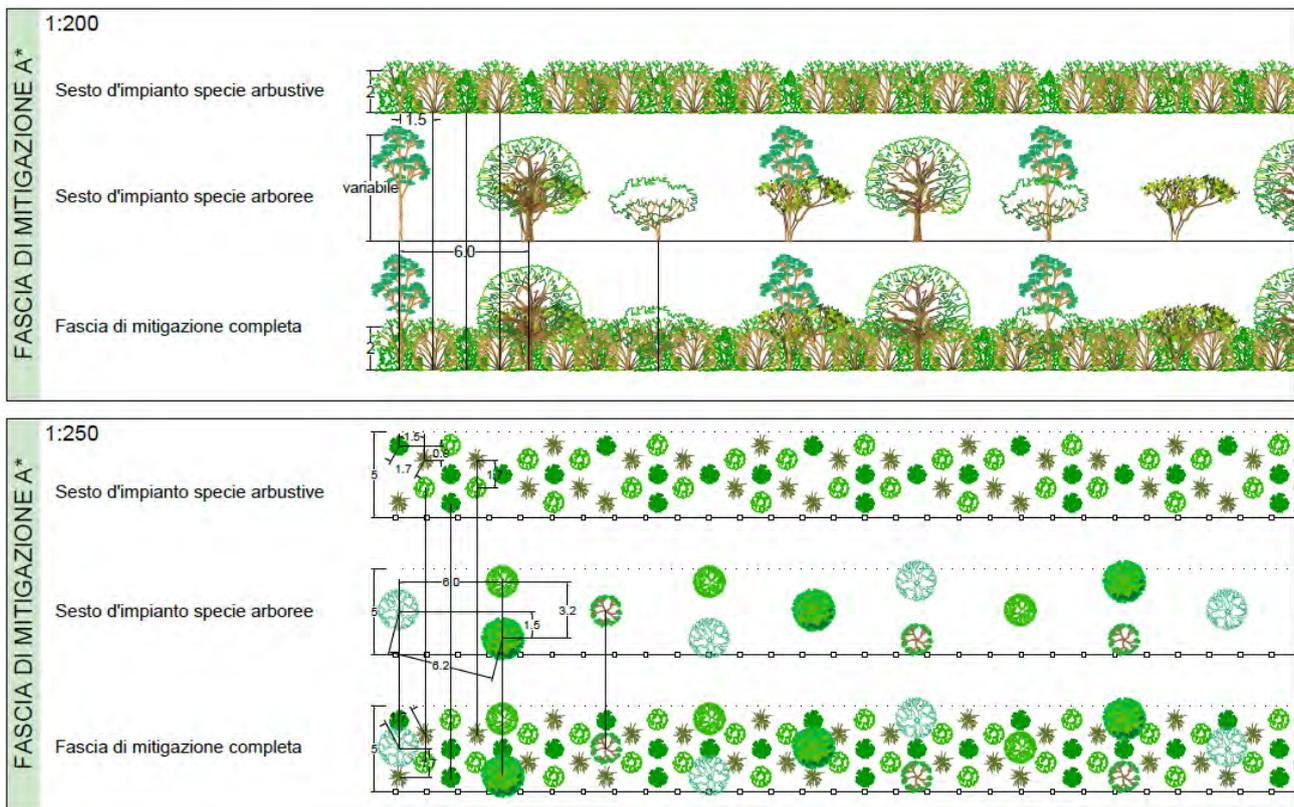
Dettaglio tipologico Fascia di mitigazione A – prospetto e planimetria
